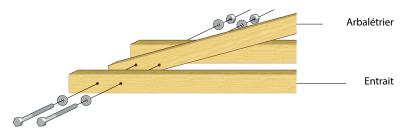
Exemple d'assemblage entrait moisé – arbalétrier par 2 boulons
